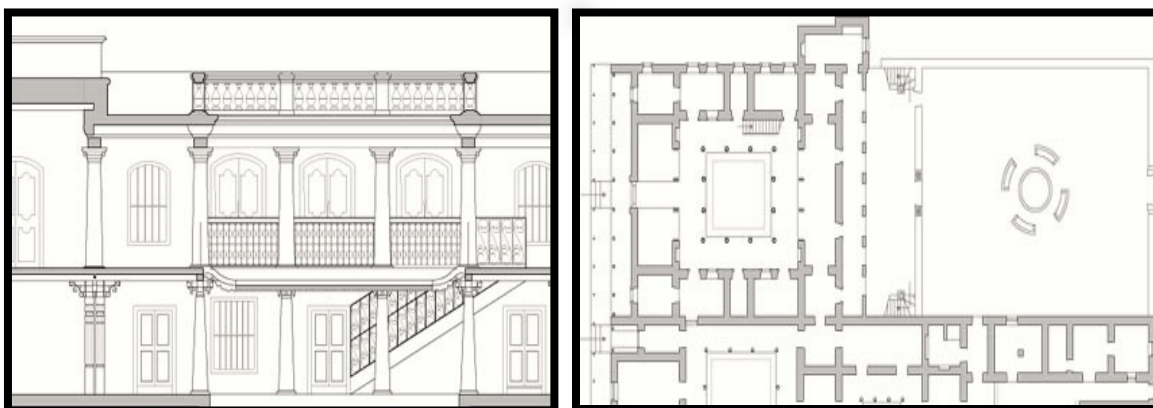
Plan de la demeure d'Ananda Ranga Pillai
